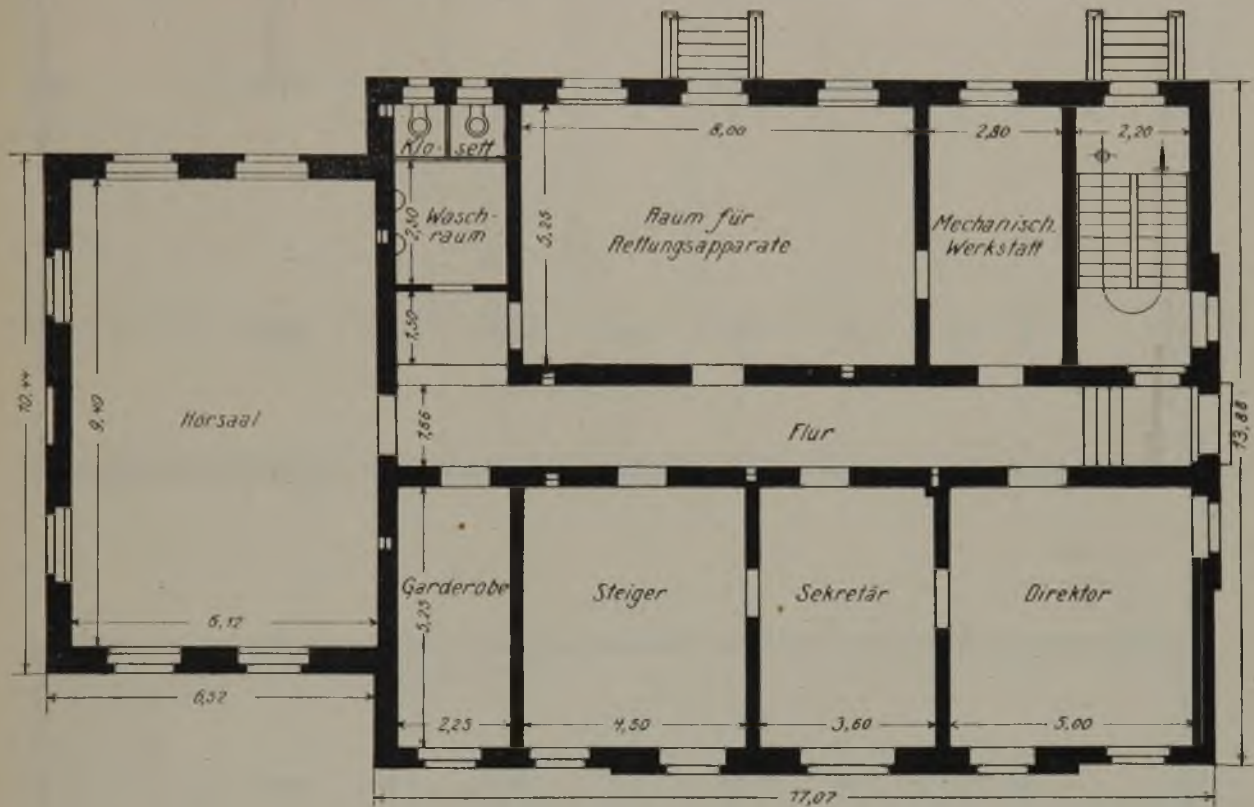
Erdgeschoßgrundriß des Dienstgebäudes.
